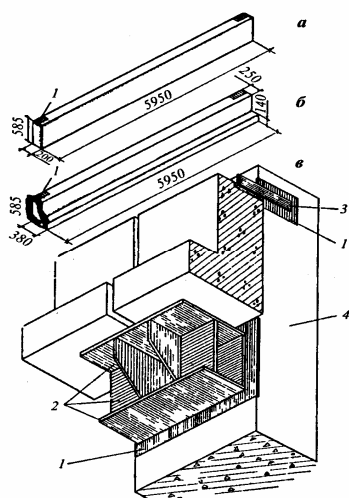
Обвязочные балки, их опирание на колонны:
